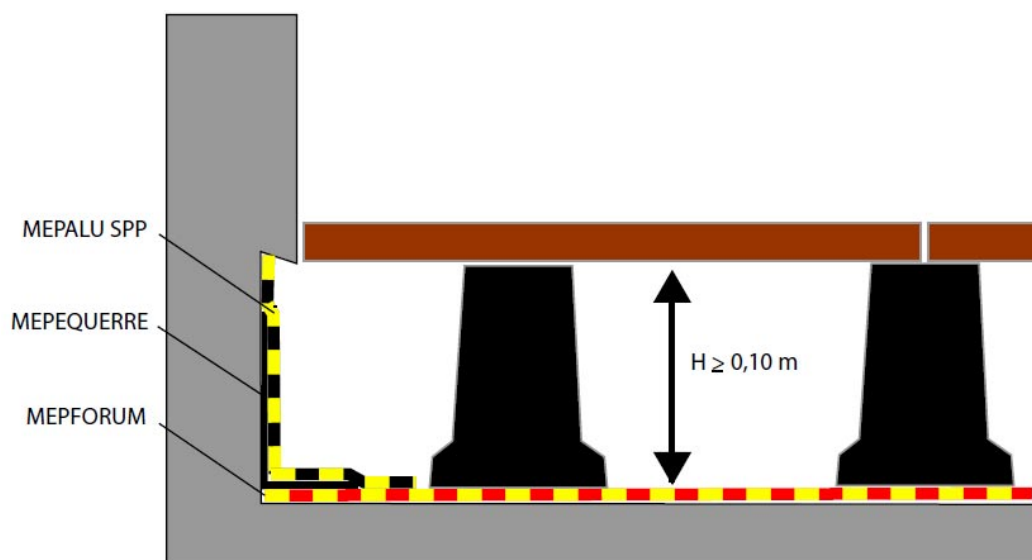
Exemple avec tête de relevé sous le niveau fini de la protection directe par dalles sur plots
